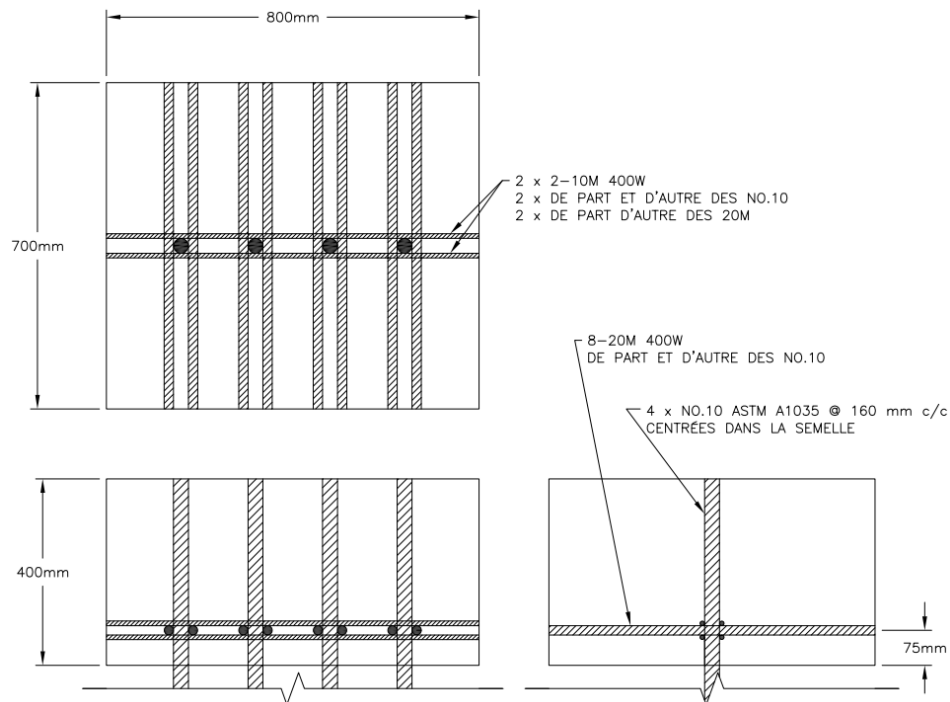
Plan des barres d'armature supplémentaires dans une semelle
